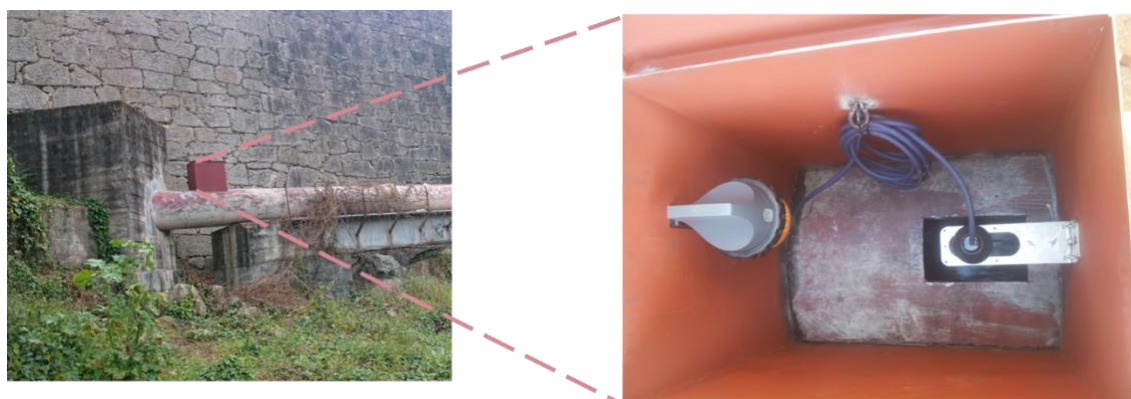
Estrutura tipo para colocação de sensor ultrassónico (fonte, Tratave)
